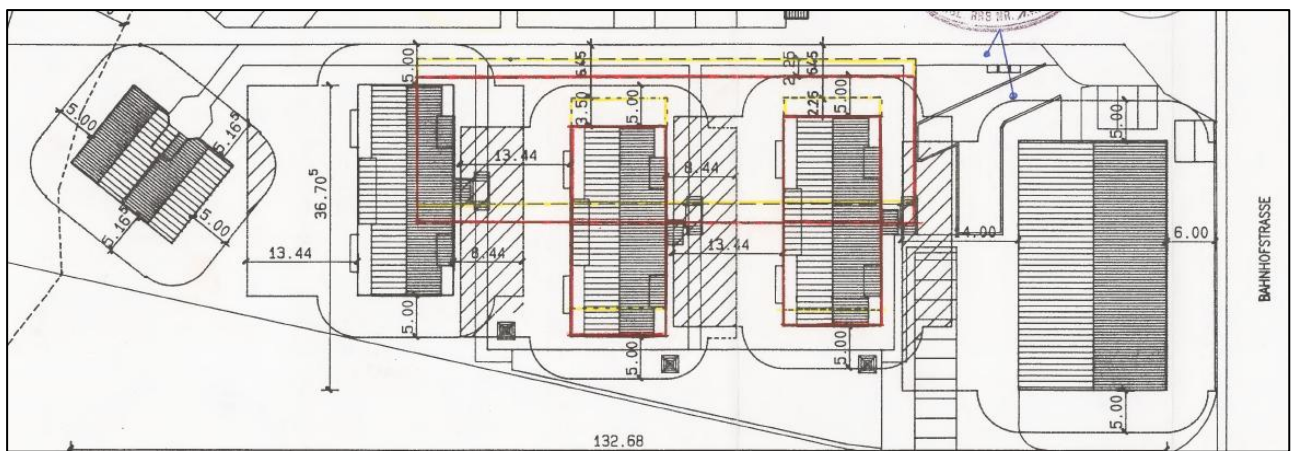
Gestaltungsplan Mühlebach: Plan 1 (Gebäudeausdehnung und Grenzabstände).
